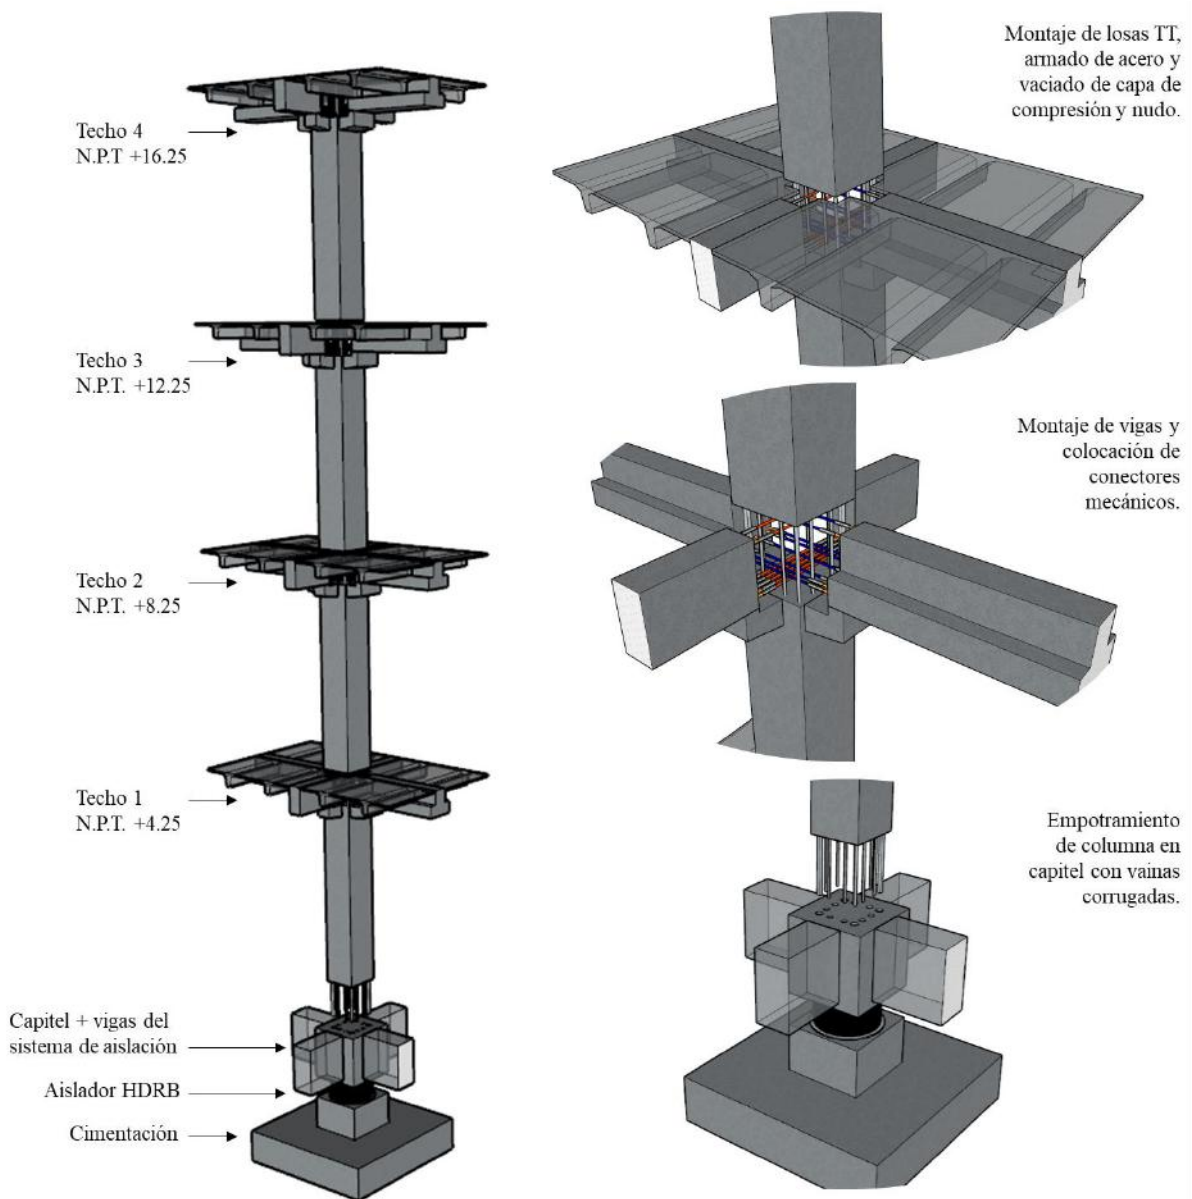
Modelo tridimensional de columna prefabricada y montaje de vigas y losas.
